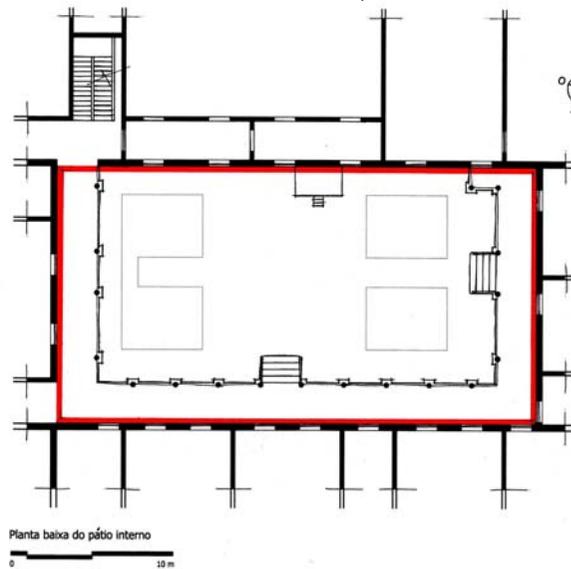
Estudo de proporção do pátio interno principal do CP11, planta baixa (Fonte: O AUTOR,2006).
